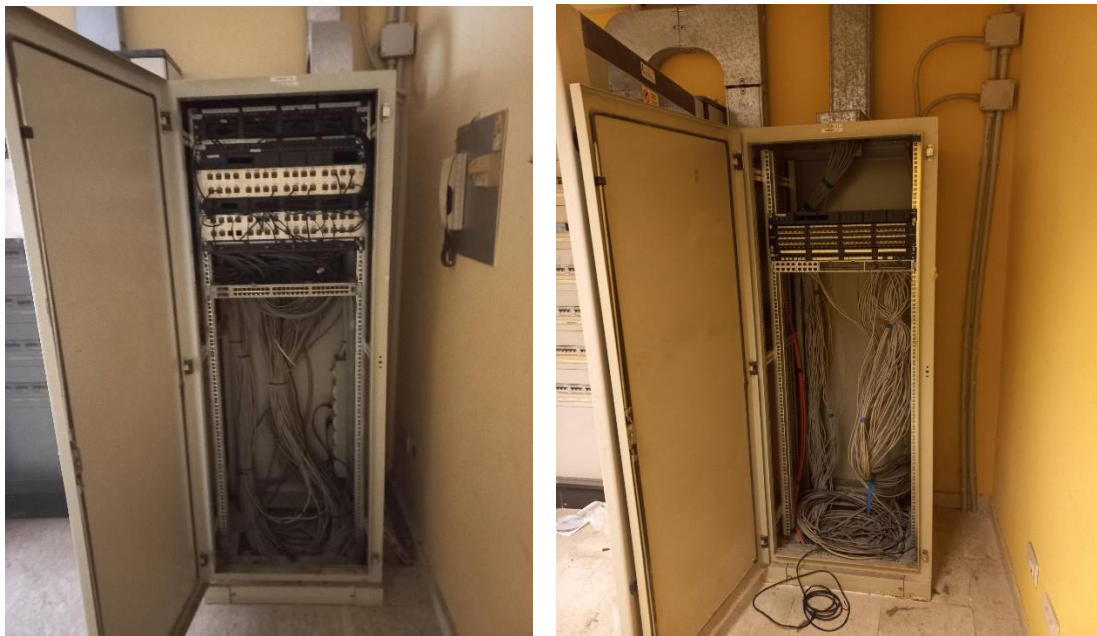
Impianto di cablaggio strutturato – Rack di piano esistente P1 P2
